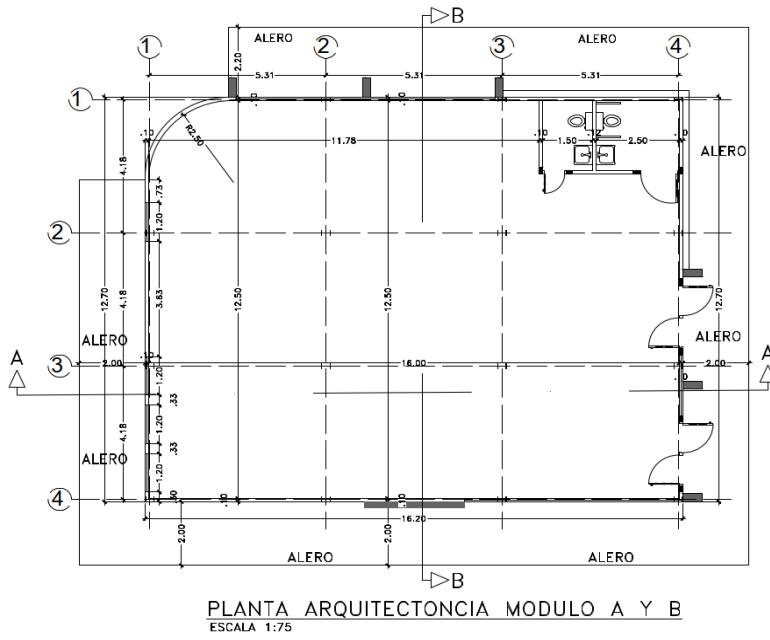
Vista panorámica de la planta arquitectónica del Módulo A y B.
